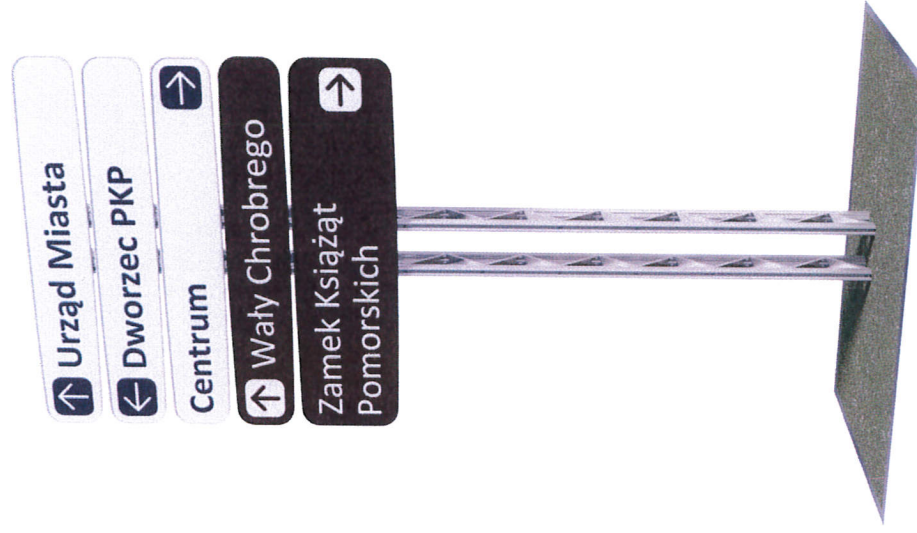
Fundamenty i konstrukcje wsporcze 1/4
